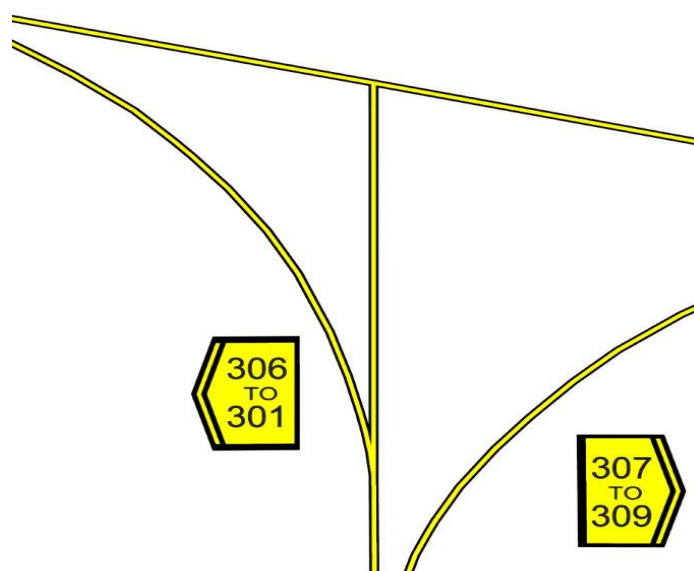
Stralcio Segnaletica di destinazione ai posti di parcheggio
